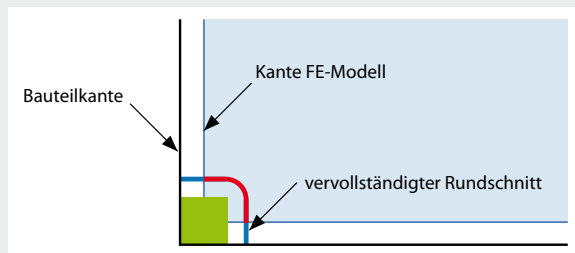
Rundschnitt im FE-Modell mit Vervollständigung bis zur Bauteilkante
